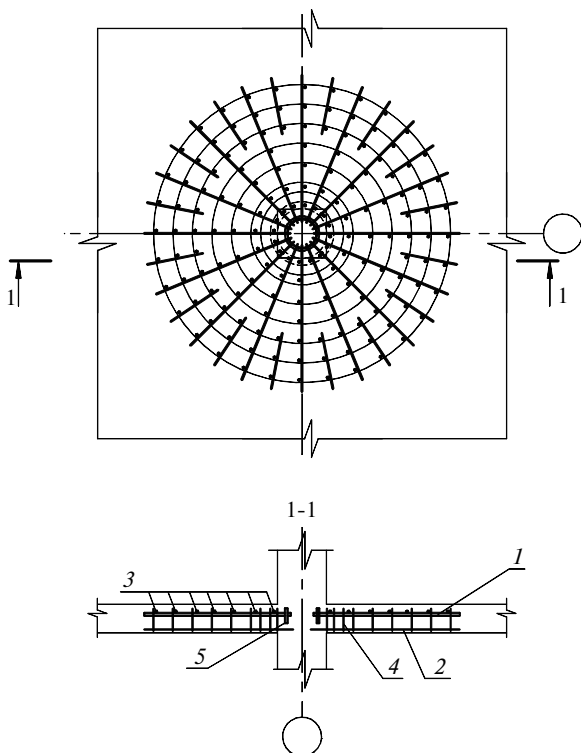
Стержни гибкой радиальной арматуры, скрепленные друг с другом посредством обрезка стальной трубы: 1 и 2 – радиальная рабочая и монтажная арматура; 3 – кольцевая арматура; 4 – поперечная арматура; 5 – обрезок стальной трубы
